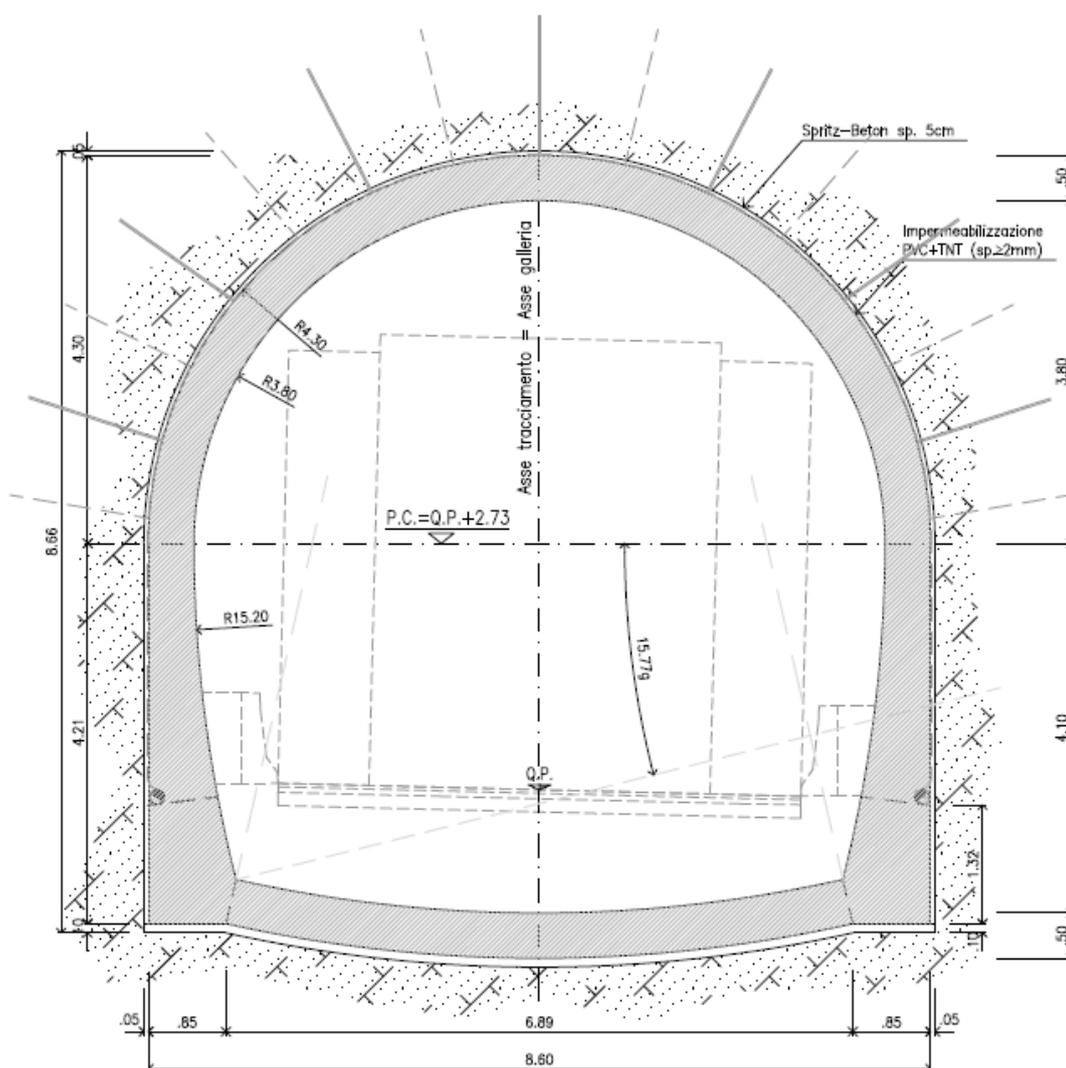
Fasi 5-6-7: Posa impermeabilizzazione e realizzazione rivestimento in.c.a. Galleria
